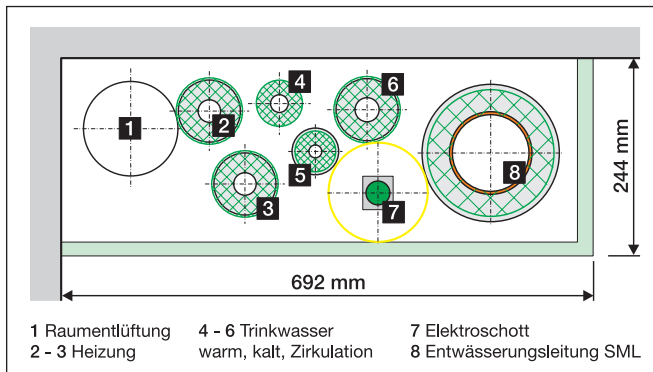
Belegungsbeispiel einer Sammeldurchführung (geplant mit PlanTec – Infos unter www.LiComTec.de>Software>InfoTec/PlanTec).
